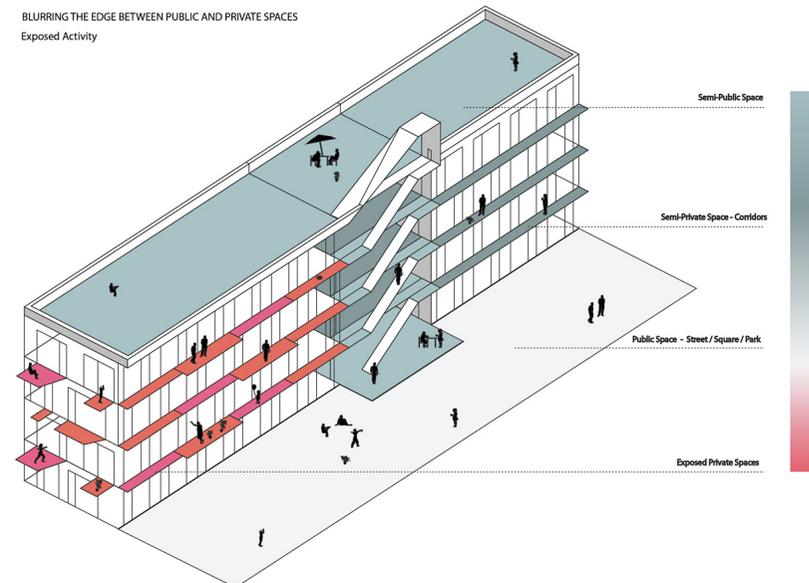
Bauplatz 4: Wohngebäude mit halböffentlichen Zonen (Ramon Bernabe Simo und Tomas Labanc)
